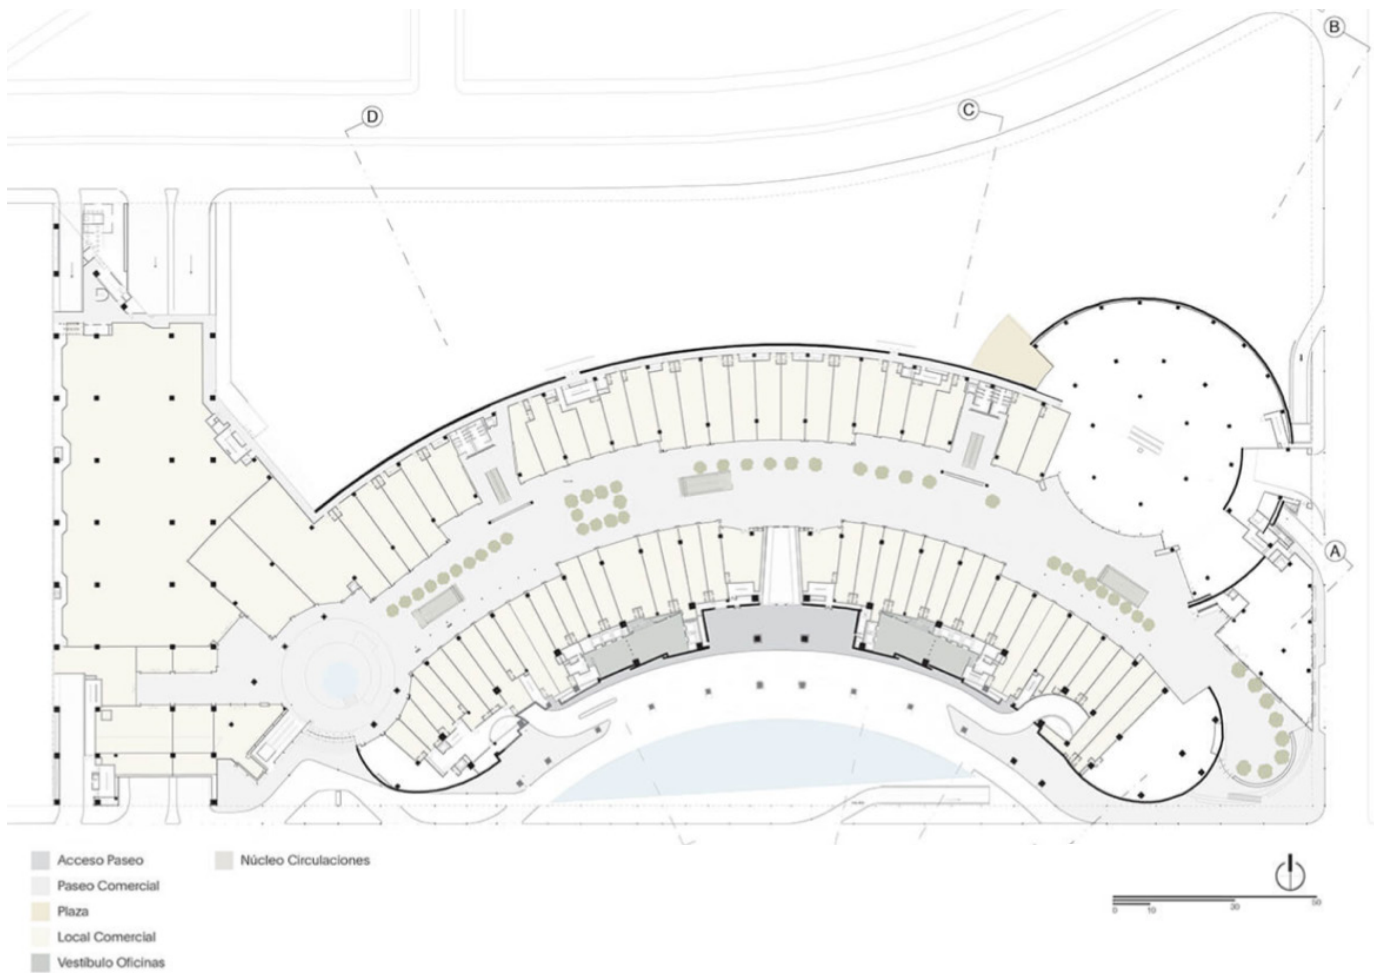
Planta Baja. Centro Comercial Antara. Fuente: Anara Fashion Hall. Sordo Madaleno Arquitectos. <https://www.sordomadaleno.com/sm/es/projects-sm/antara-fashion-hall> .Recuperado el 29 de abril de 2020.
